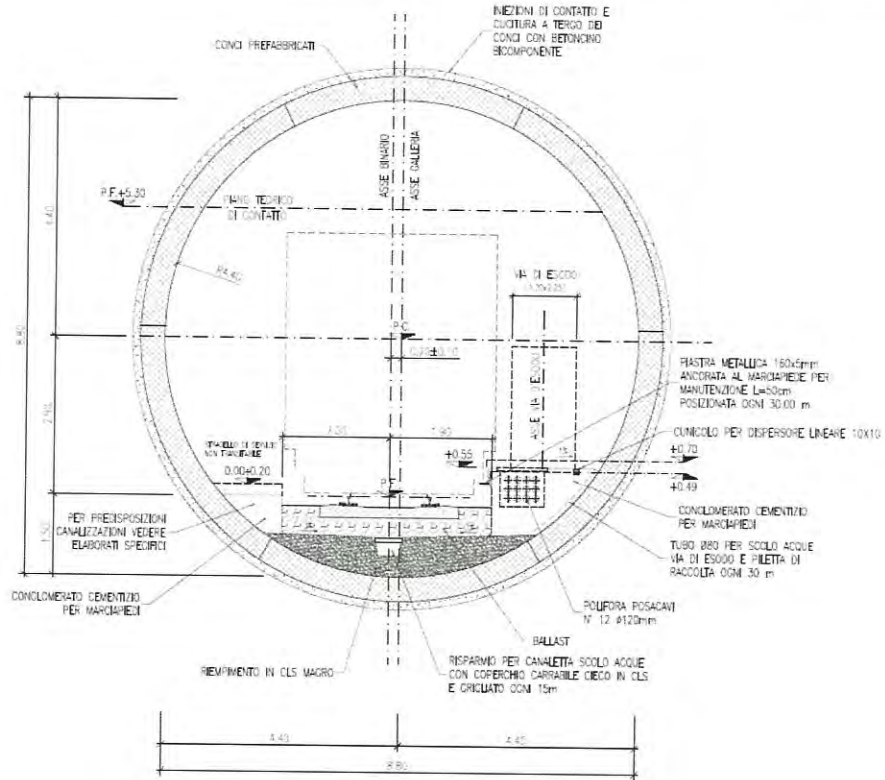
Progetto Esecutivo galleria Lonato, sezione tipo a singolo binario.
